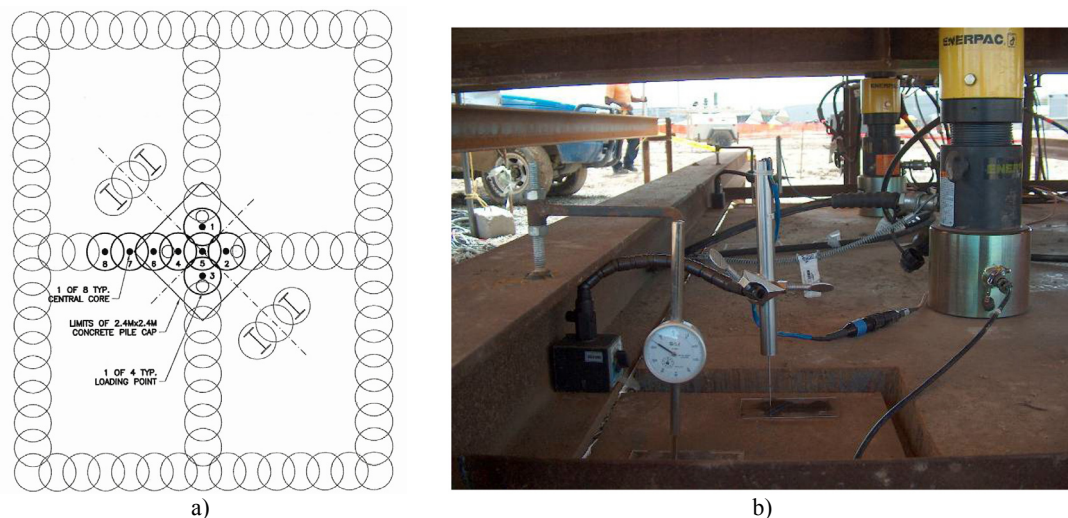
Ensaio de carga em colunas DSM : a) planta das colunas de DSM; b) configuração do ensaio de carga (Bell *et al.*, 2007)
